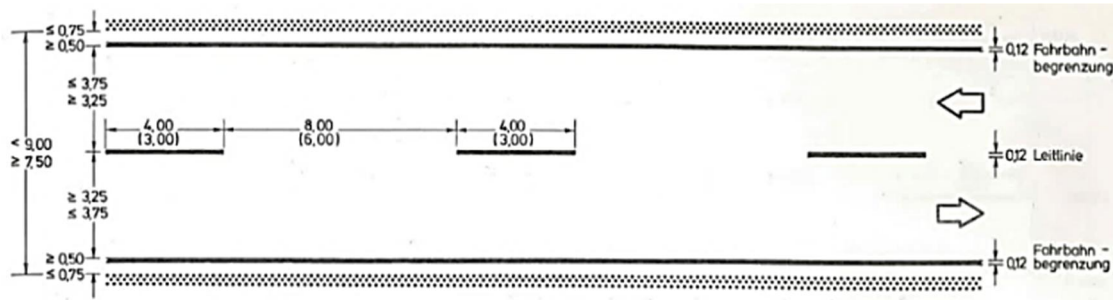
Markierung einer Bundesstraße mit einer bebauten Breite von 7,5 m bis 9,0 m [67]
